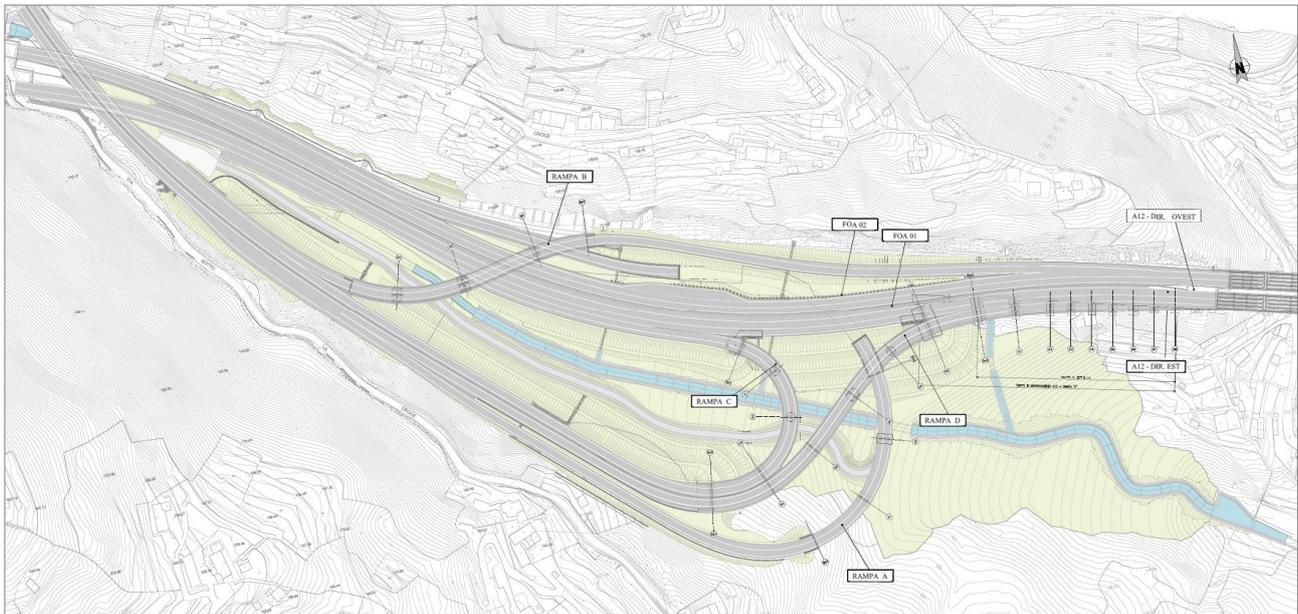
Planimetria del nuovo svincolo A12 – Progetto ottimizzato
